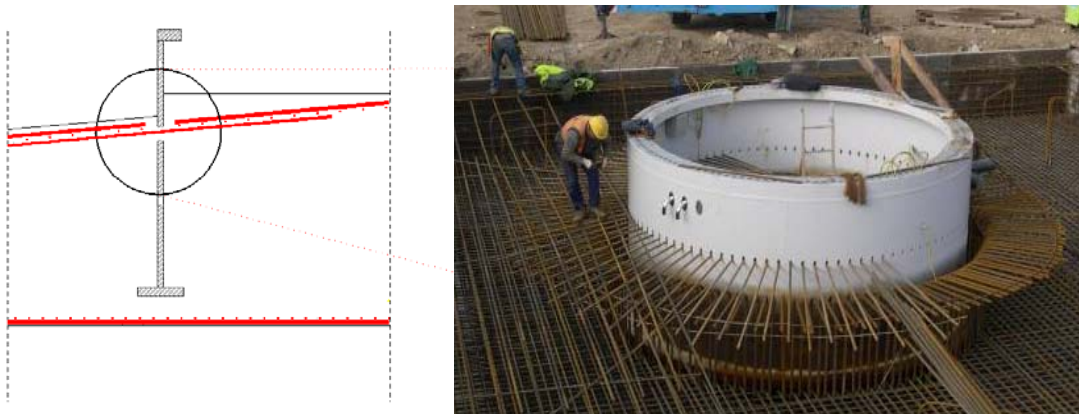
Pormenor da armadura superior que atravessa o anel metálico
